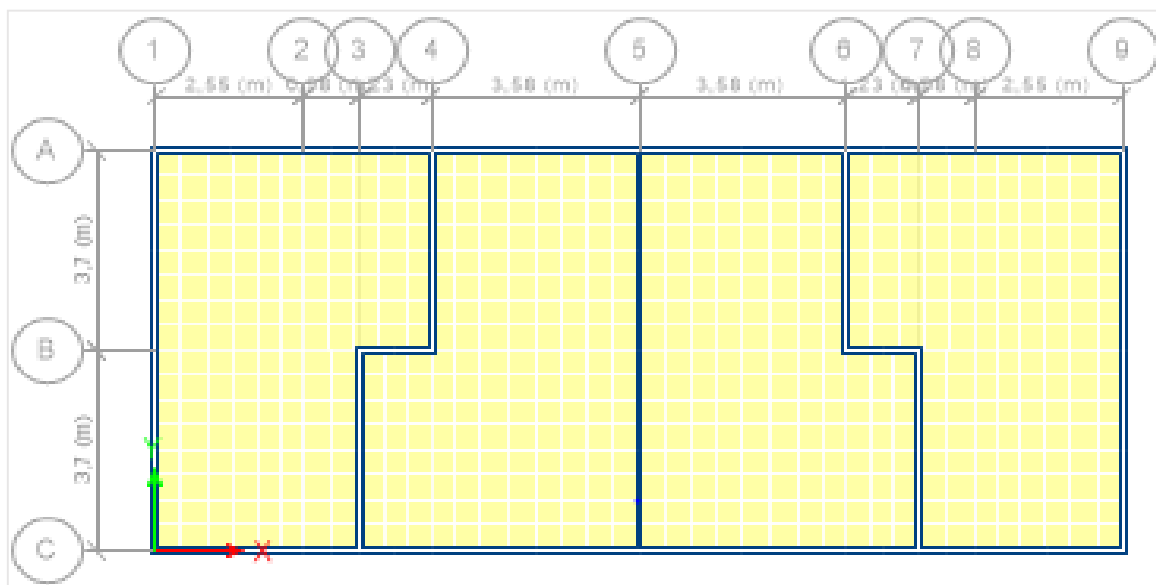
Muros Planta Baja de Conjunto de casas C82. Nivel N+2,40
